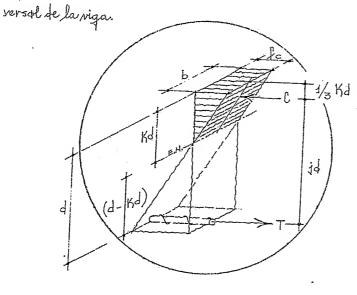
p. Deforma\_ ción de la viga bajo la acción del momento \_ flexionante.
